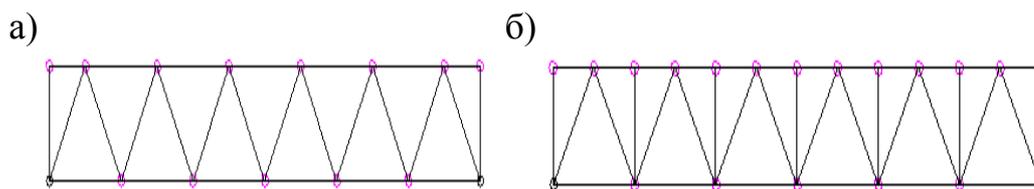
Варианты решеток ферм: а – без промежуточных стоек; б – с промежуточными стойками
